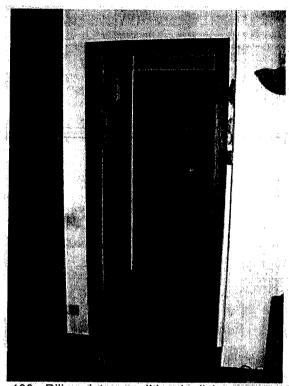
Rilievo interno - Il locale disimpegno ad Est.
